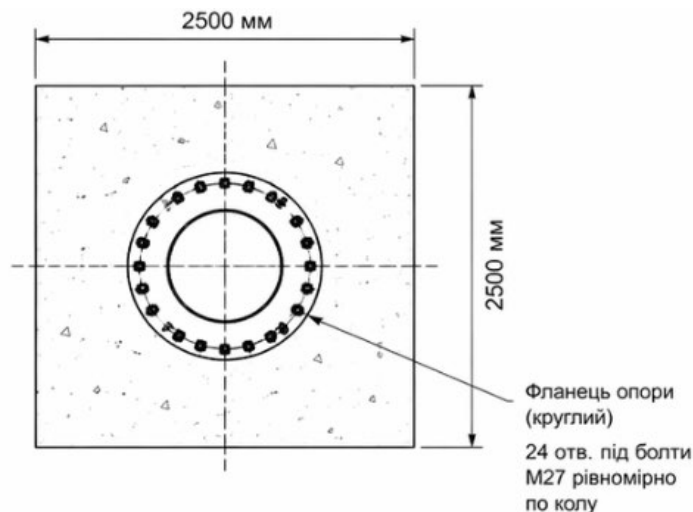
План кріплення опори ВЕУ до фундаменту [27]
